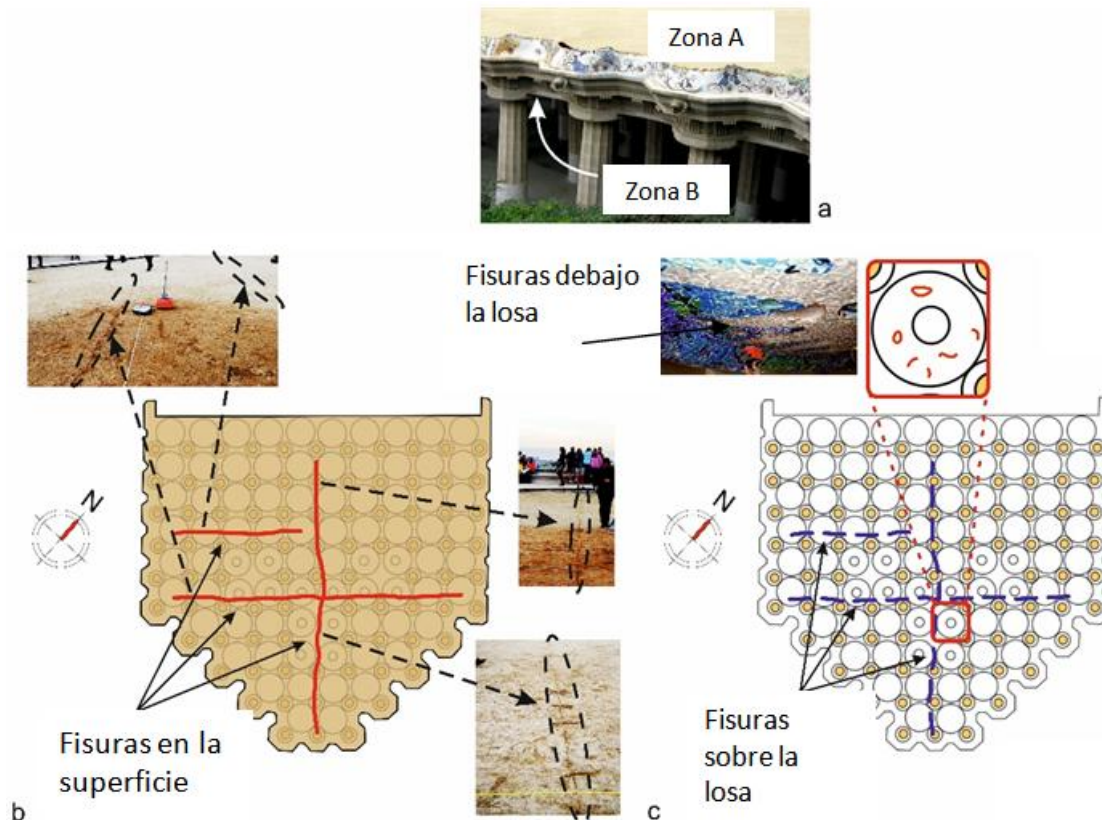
a) Fotografía que muestra la situación de las dos zonas estudiadas, A y B. La zona A está en la plaza, en la parte superior de la losa, cubierta de suelo arenoso; la zona B está en el techo de la sala hipóstila, en el fondo de la losa cubierta con revestimiento de fragmentos de cerámica. b) Fracturas observadas en la zona A en la inspección visual. c) Daño observado en la zona B, en uno de los casquetes esféricos de las bóvedas del techo inferior de la sala hipóstila.
